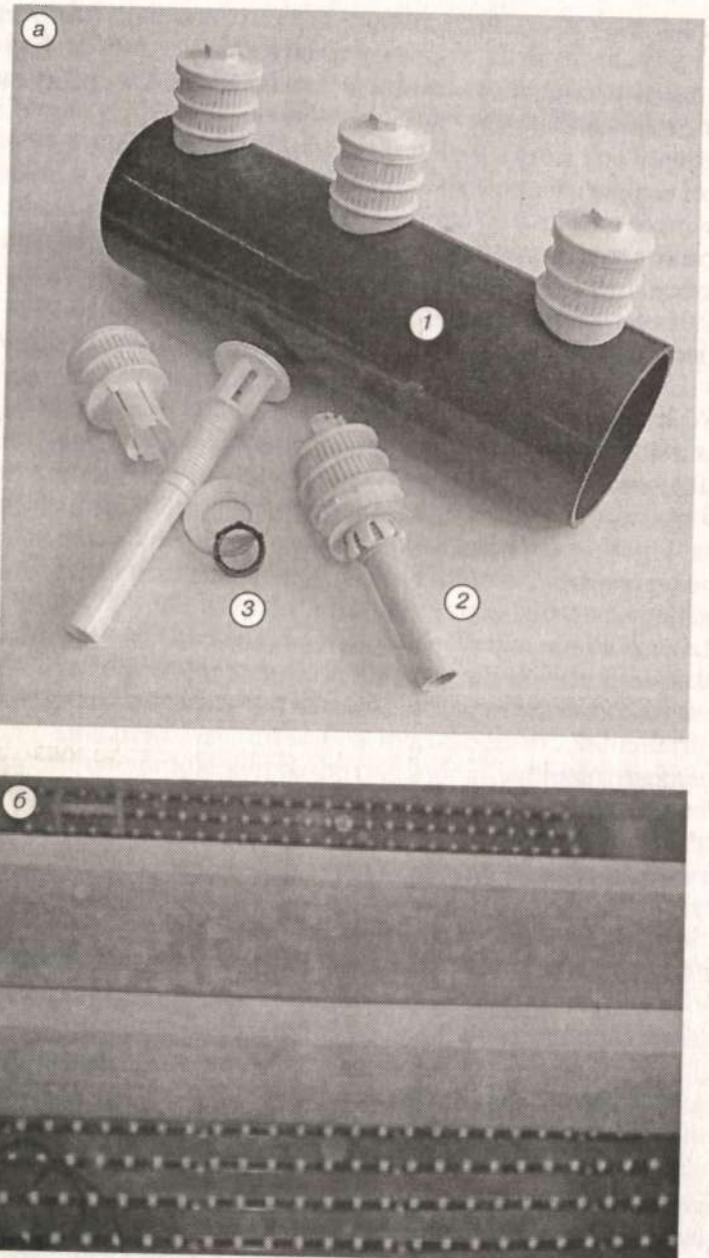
Дренаж для водовоздушной промывки фильтров:
